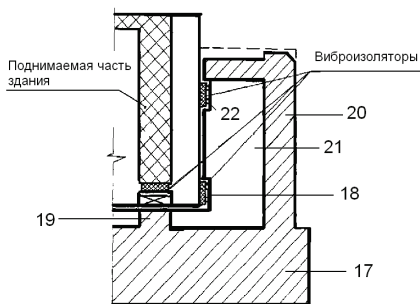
Схема виброизоляции цокольного этажа в основании здания.
